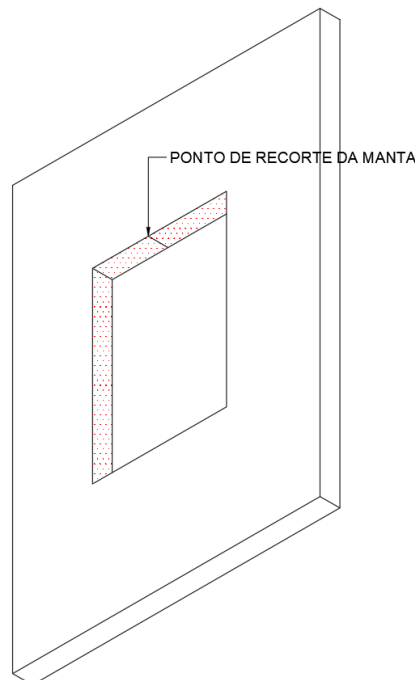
Vão com a estrutura do Steel Frame aparente
